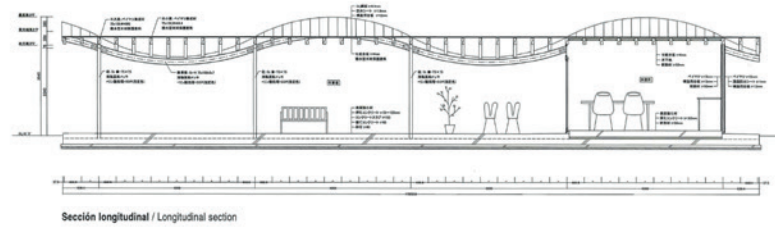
Plan du projet Home for All de SANAA, crédit El Croquis.
